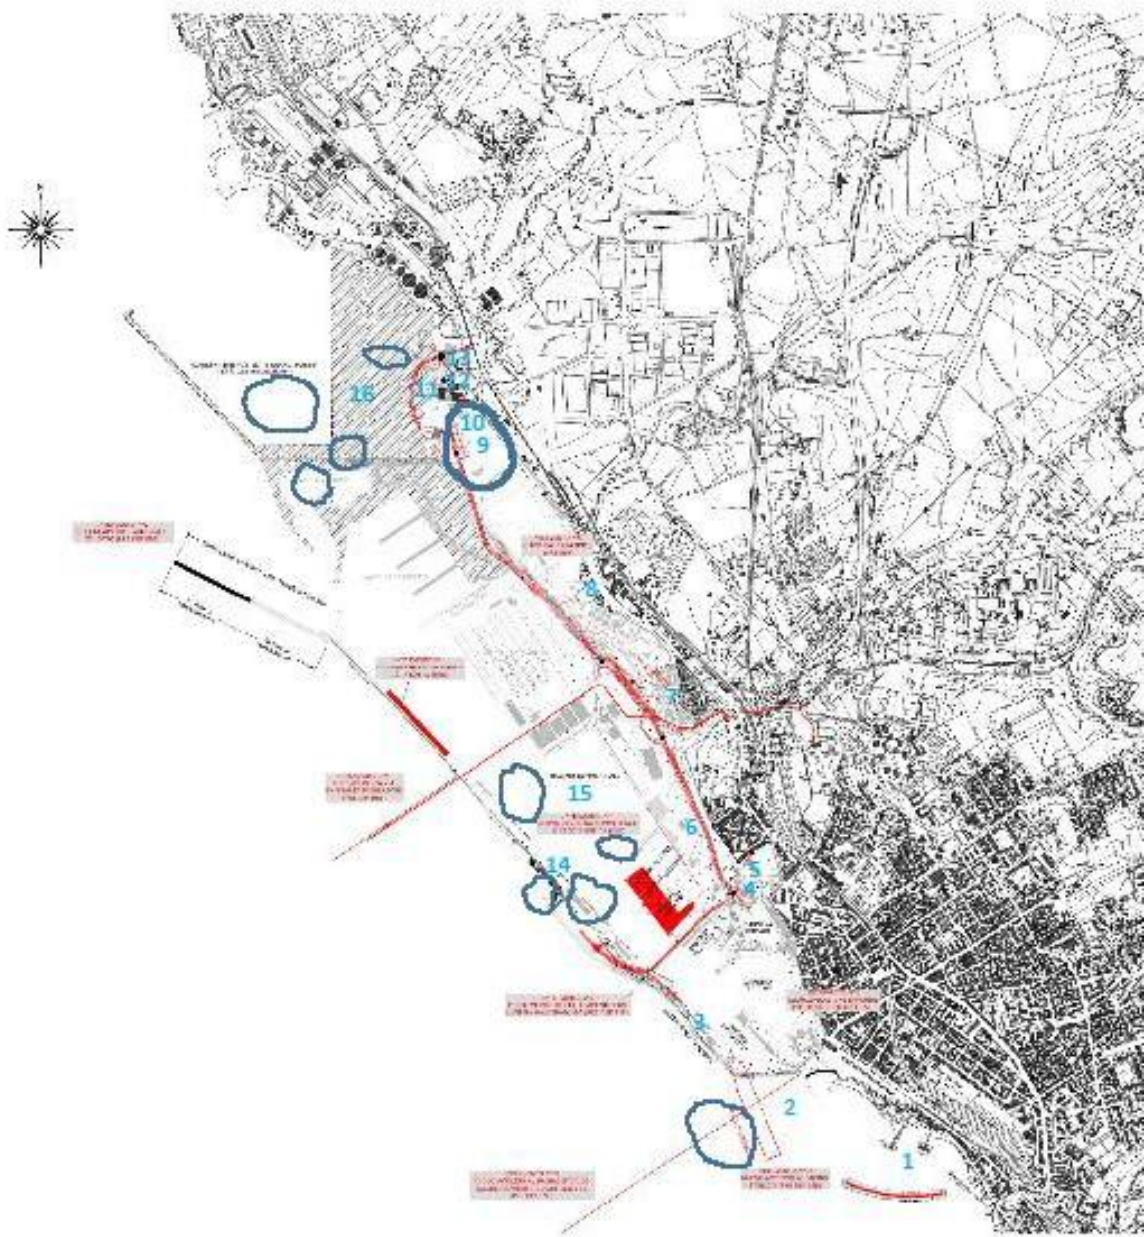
Individuazione delle preesistenze sulla planimetria da progetto
